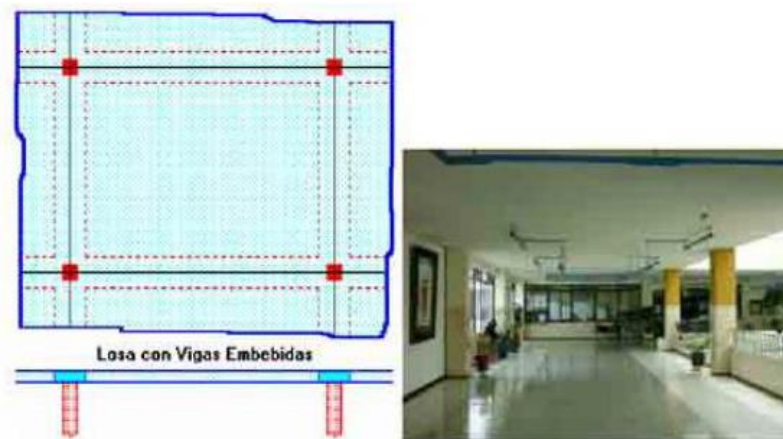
Losa plana con vigas bandas [Romo,2008]
